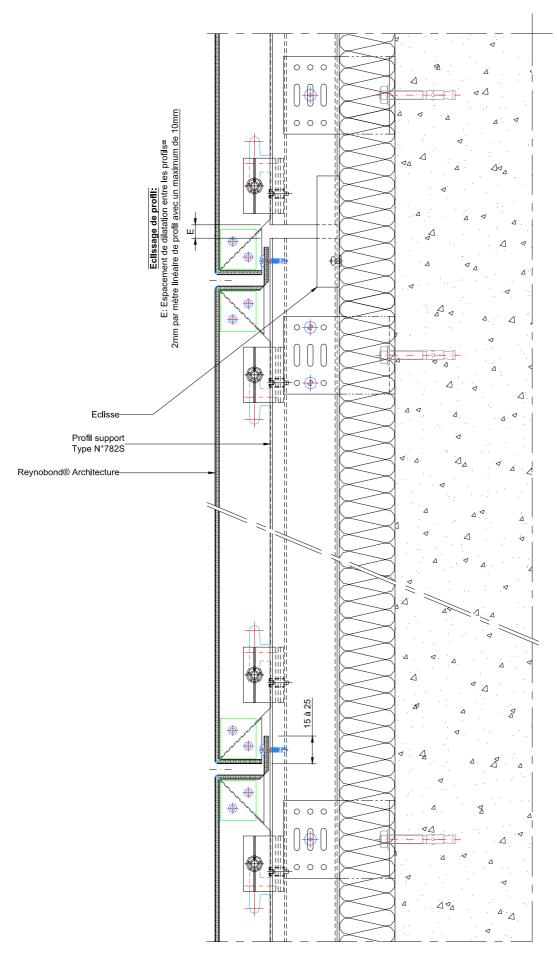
Emplacement du raccord de dilatation entre les éléments d'ossature – Coupe verticale
